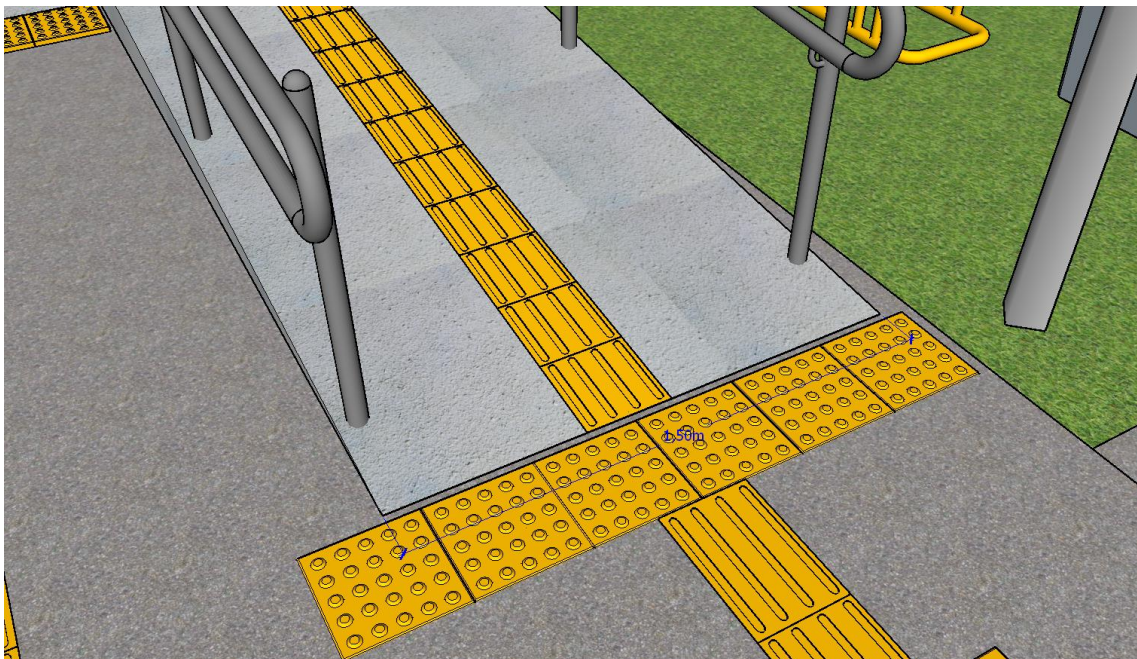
Vista do acesso por rampa do modelo de projeto
